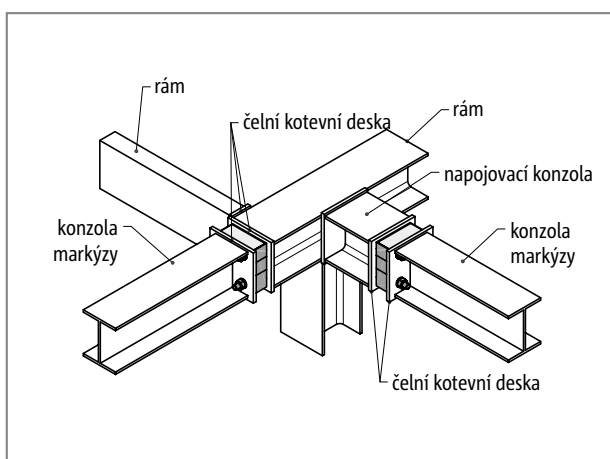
Schöck Isokorb® T typ S-N a T typ S-V: Volně vyložená ocelová konstrukce
